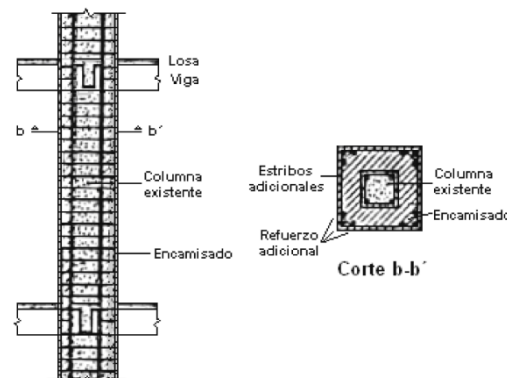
Encamisado hasta la losa. Fuente: Soto (2008)
